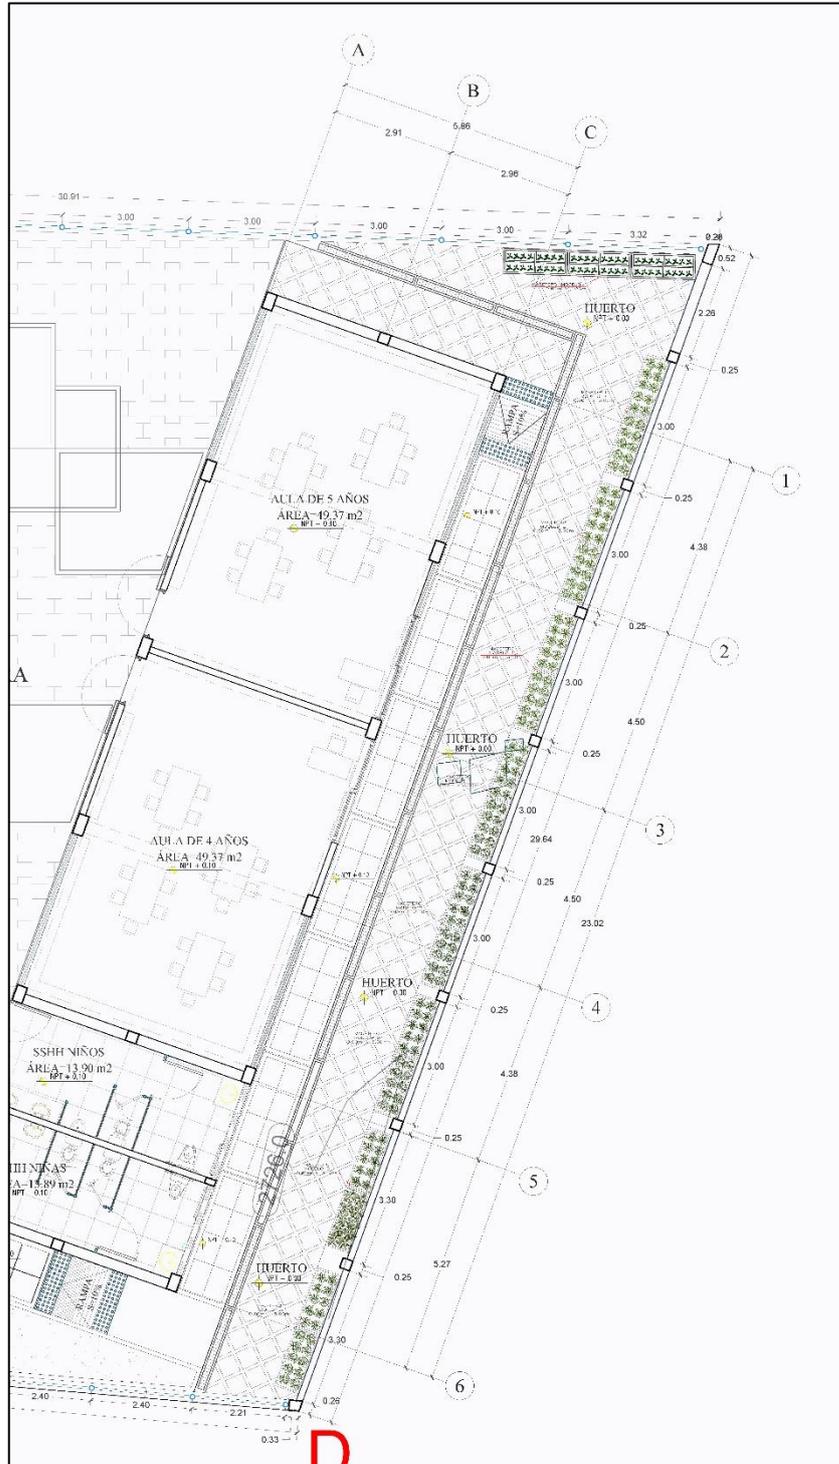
Distribución del huerto en la planimetría de la I.E.I. N°246
